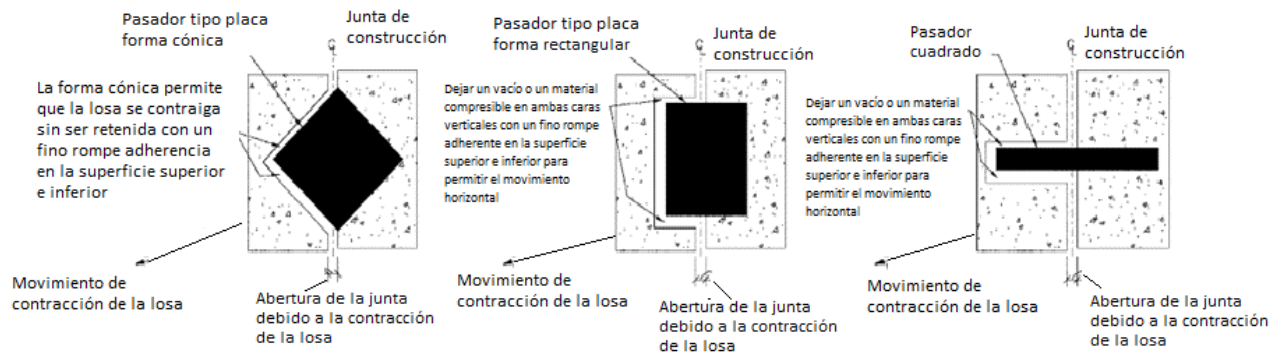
Vista en planta indicando las disposiciones para el movimiento longitudinal en juntas de construcción con pasadores (ACI 360, 2016)
